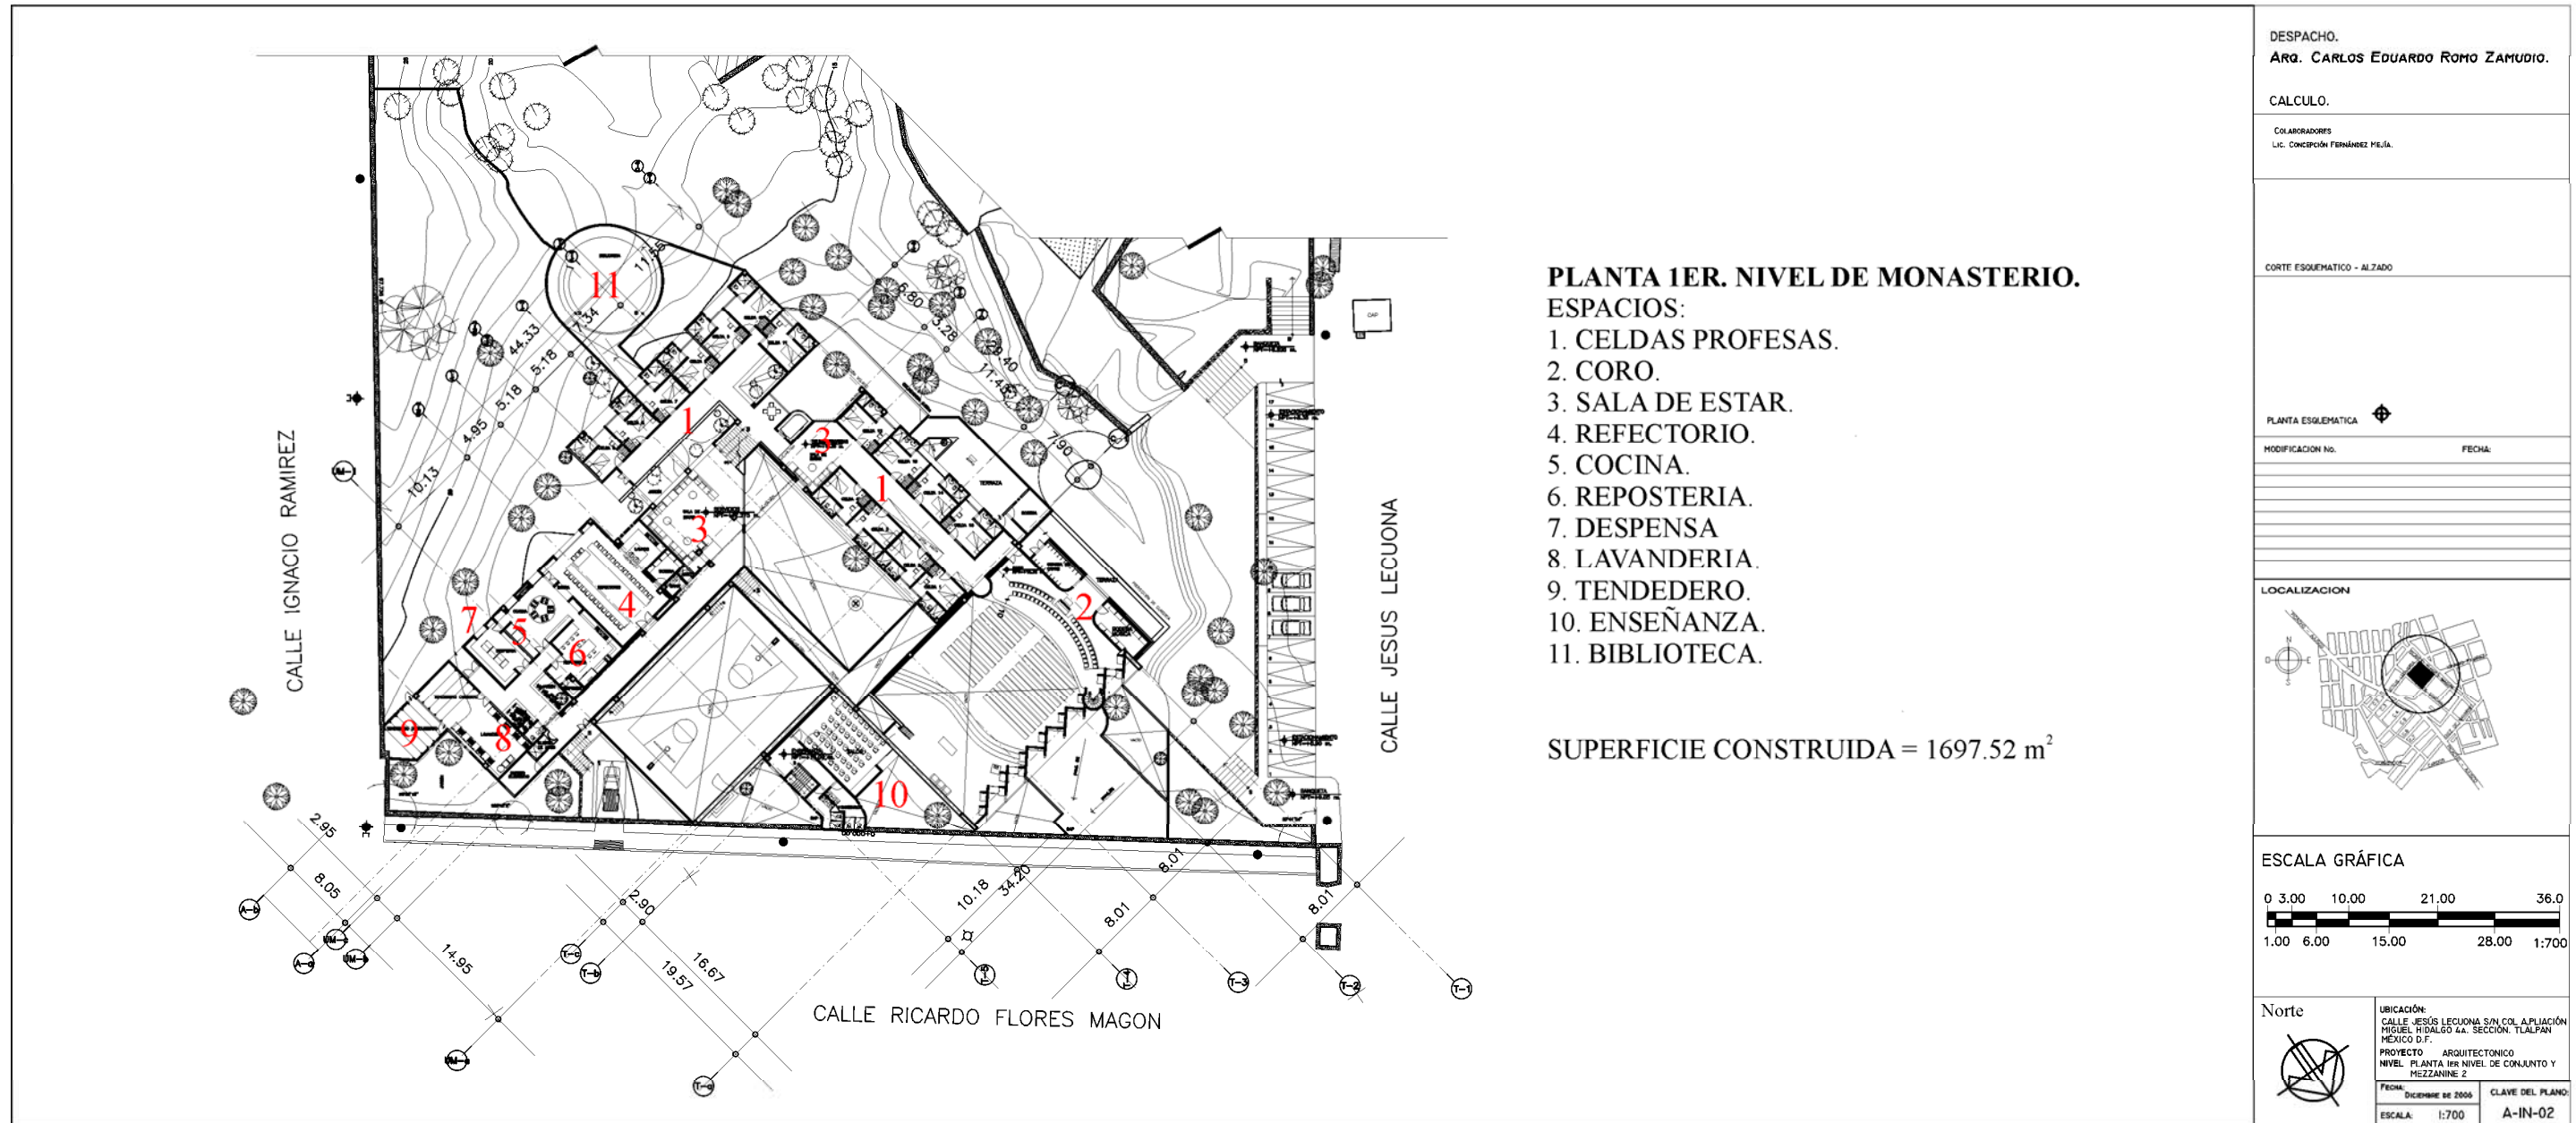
El proyecto arquitectónico. Primer nivel. CRZ
